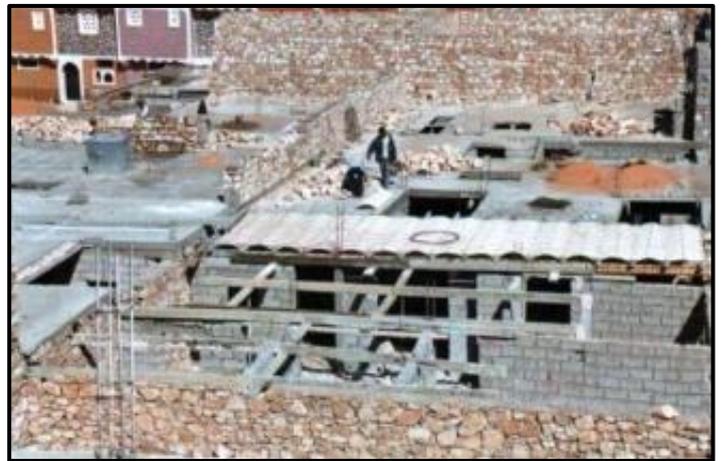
Photo de chantier de ksar Tafilalt Tajdit
